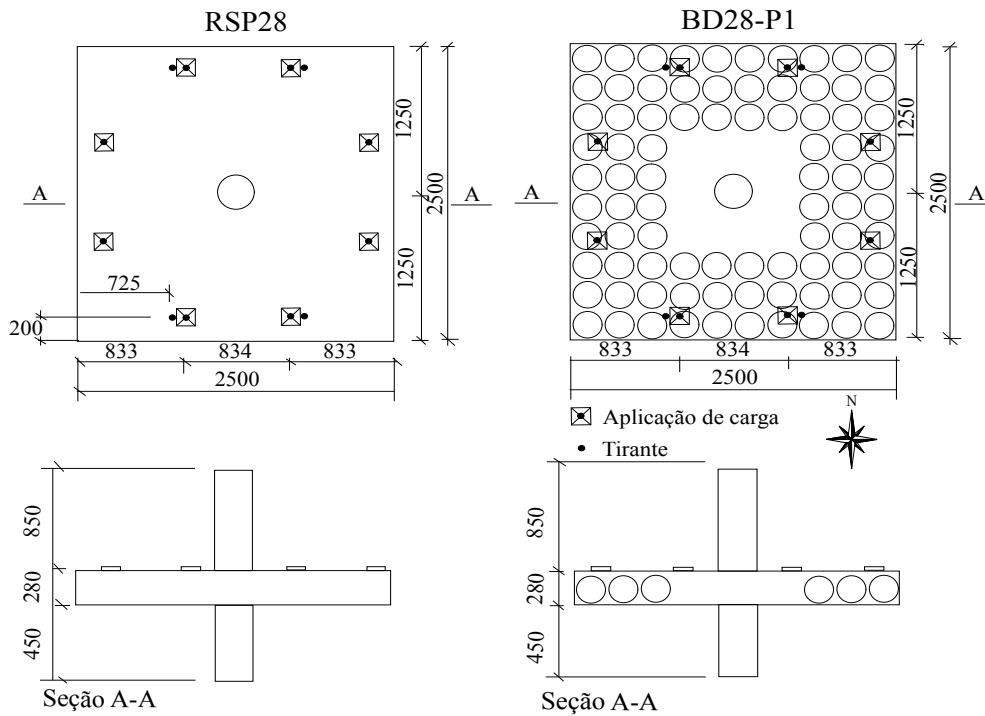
Dimensões das lajes ensaiadas, Lima (2015)
